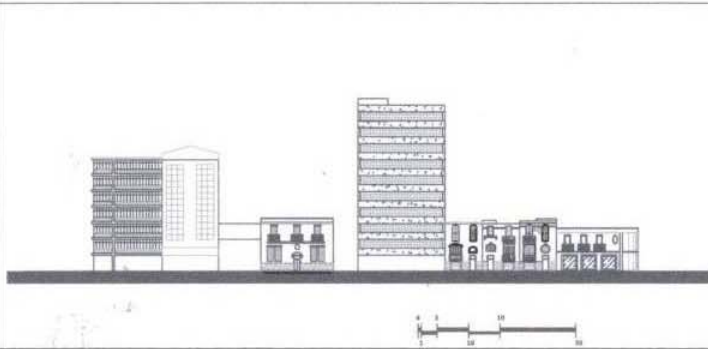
Perfil urbano de la calle de Puebla entre Orizaba y Jalapa
